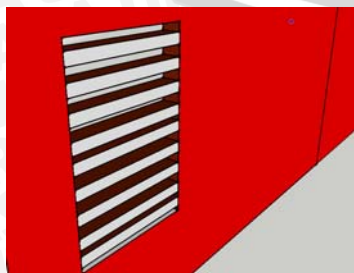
Tipe bentuk bangunan pada pantai Blimbingsari
